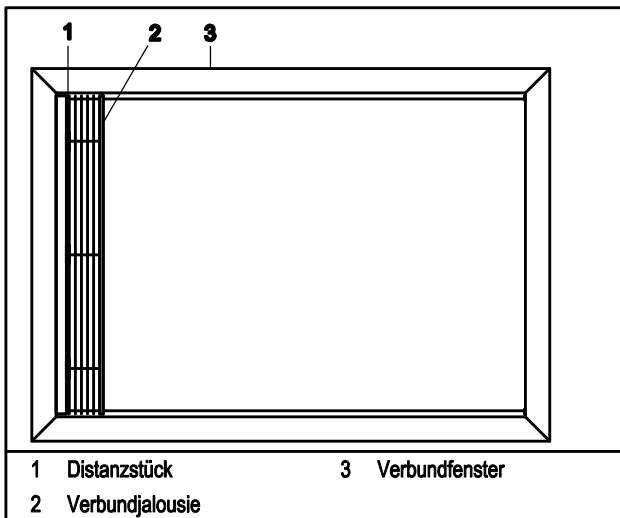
Element senkrecht liegend, Lamellen vertikal, Behang hochgefahren
